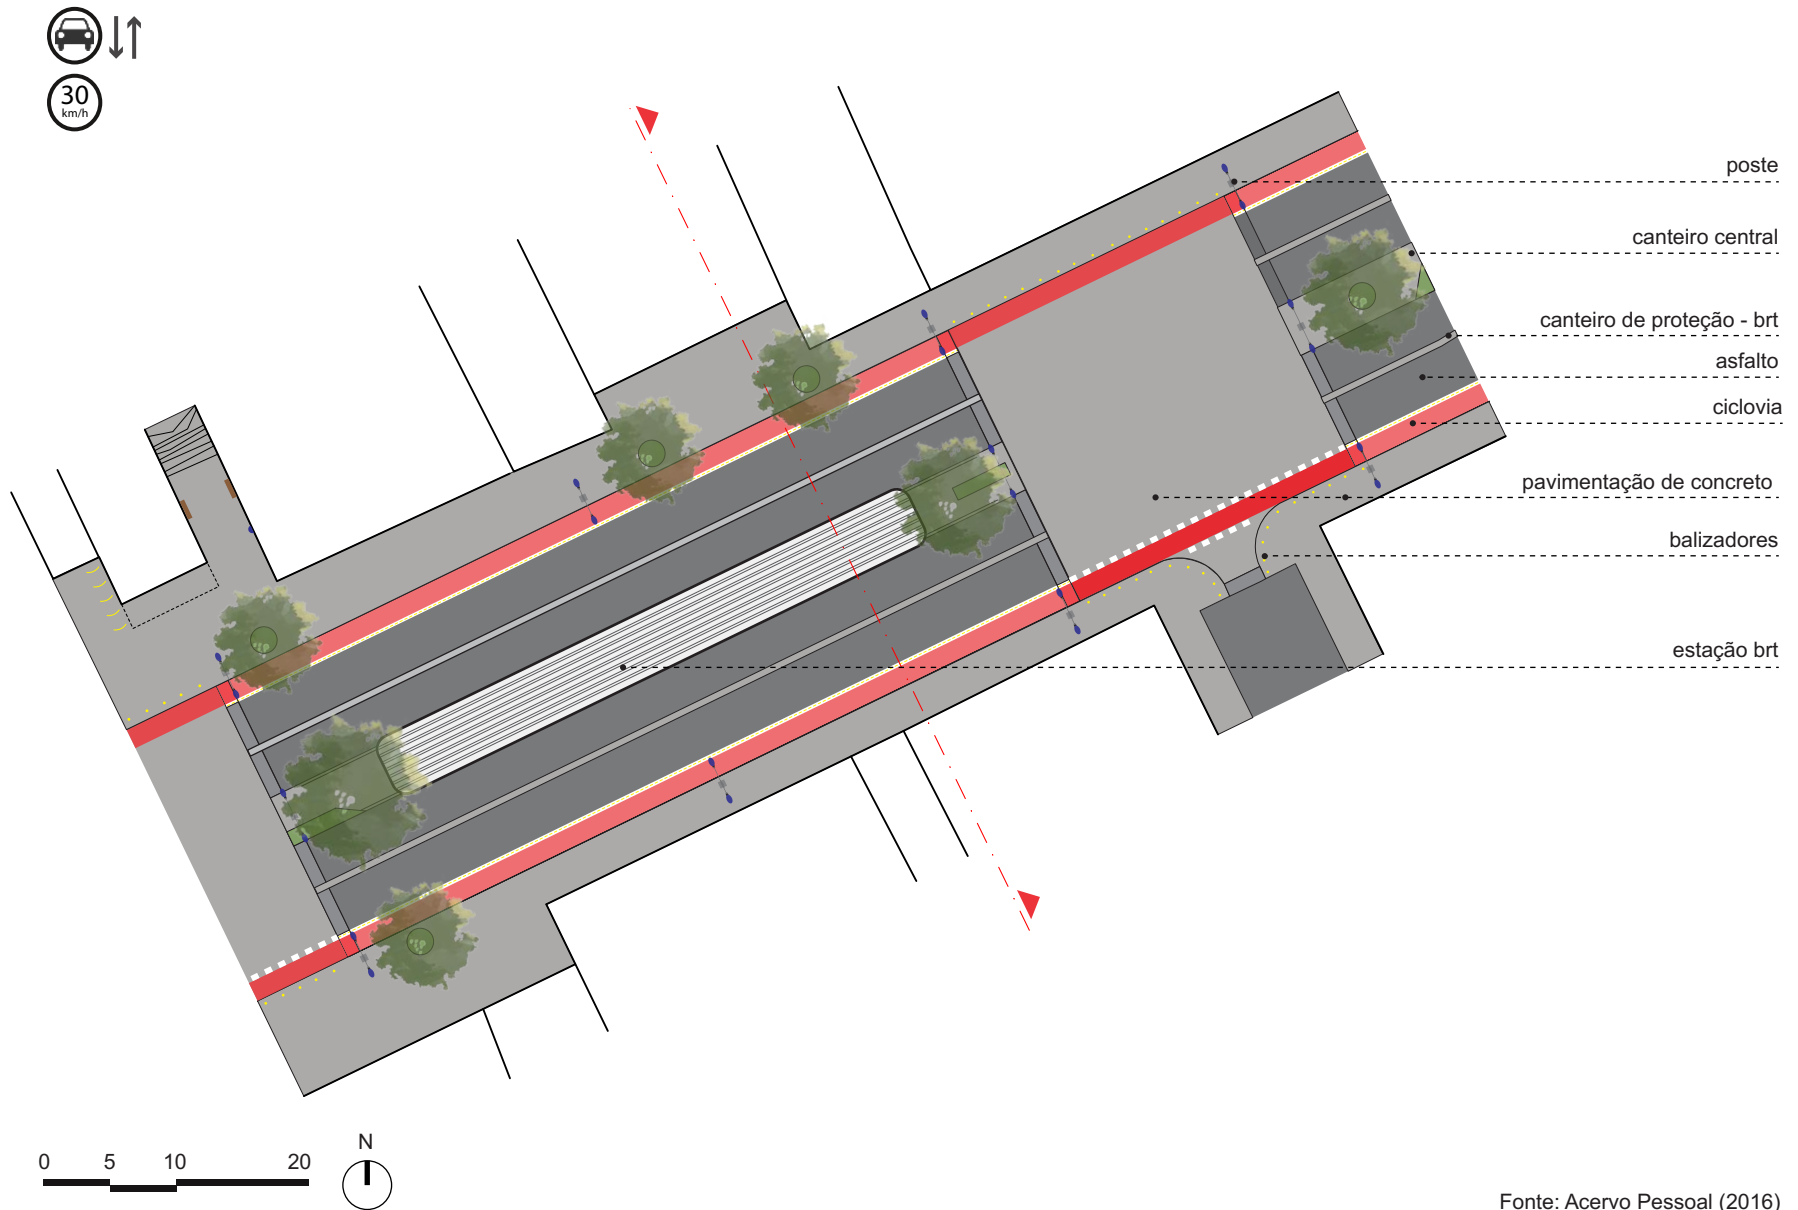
Recorte Avenida Floriano Peixoto - antes
